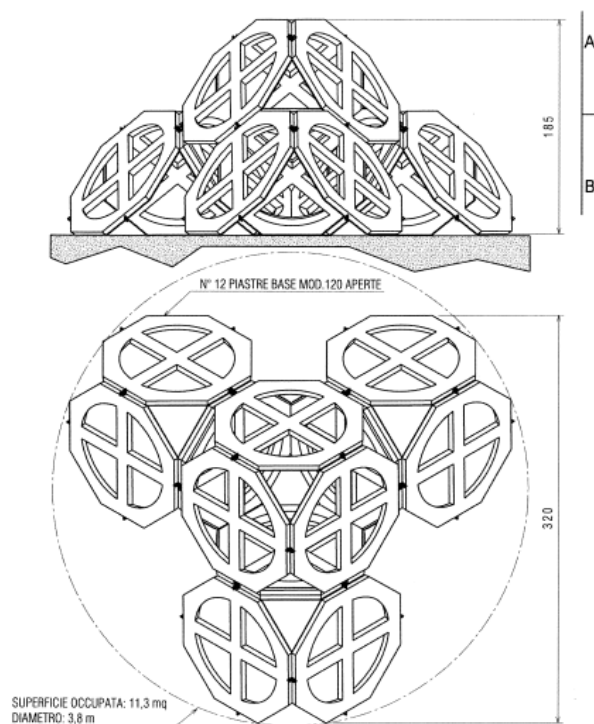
Barriera “Tipo 2”; Struttura Tecnoreef da n° 10 celle base, 12 piastre Tecnoreef Mod. 120 aperte.
